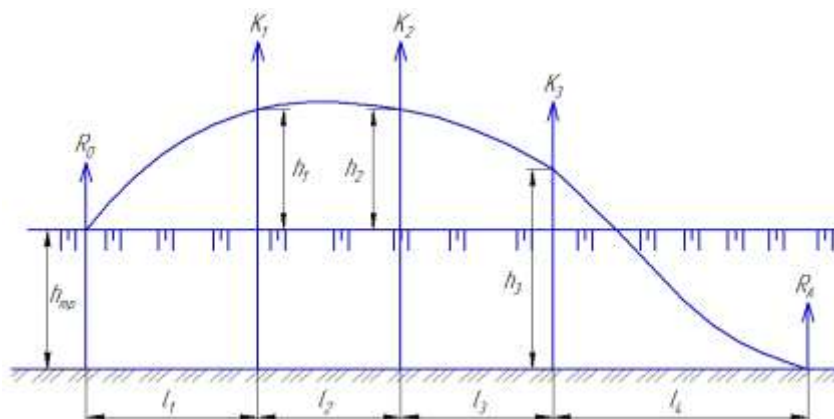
Расчетно-технологическая схема укладки трубопровода
